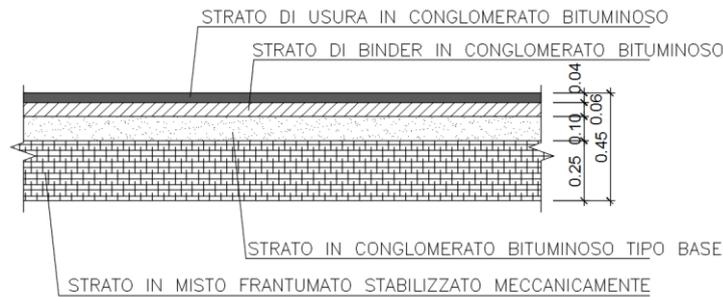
Pacchetto pavimentazione Strada F Locale Extraurbana
